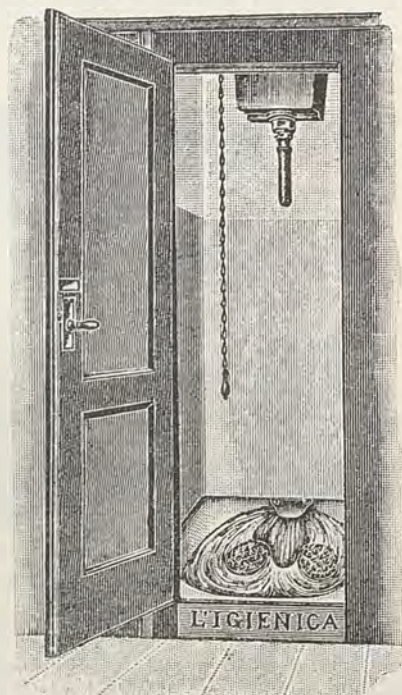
Latrina con vaso-pavimento della Ditta Lossa (Milano).
